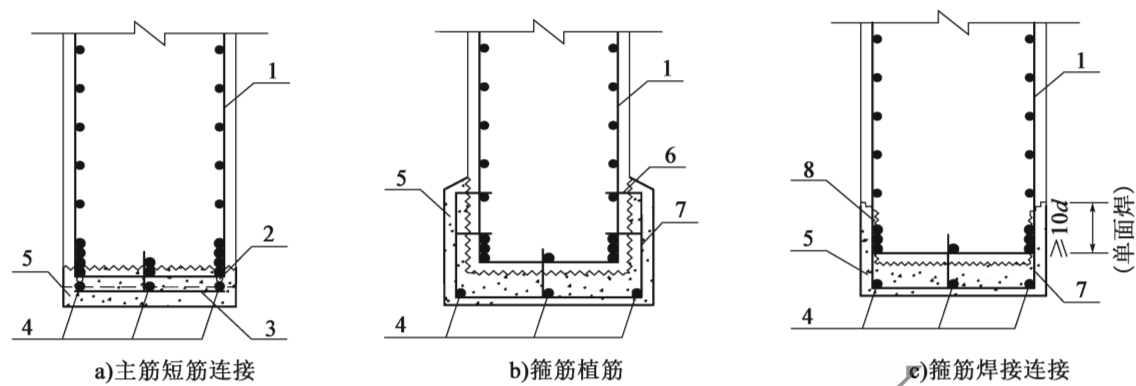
受弯构件新增纵向受拉钢筋连接构造示意
